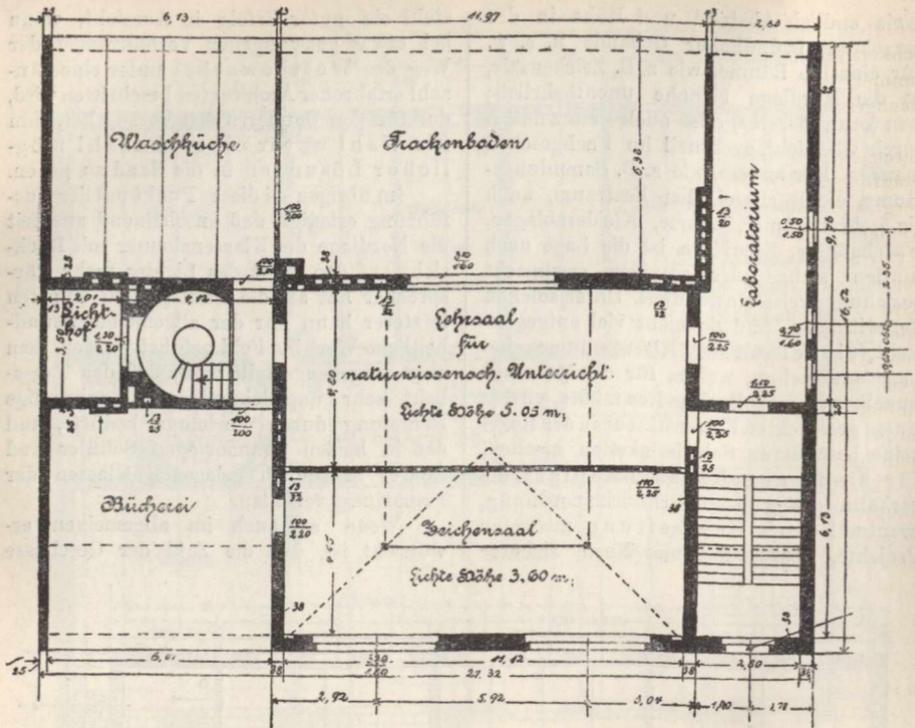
Grundriß des Dachgeschosses der Höheren Mädchenschule von Dr. Lorenz in Friedenau bei Berlin.
